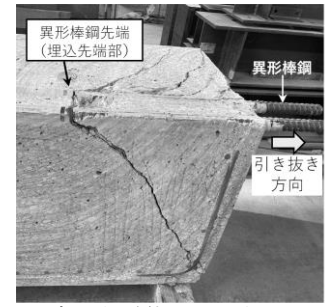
供試体切断で確認した内部ひび割れ (Case-4)
